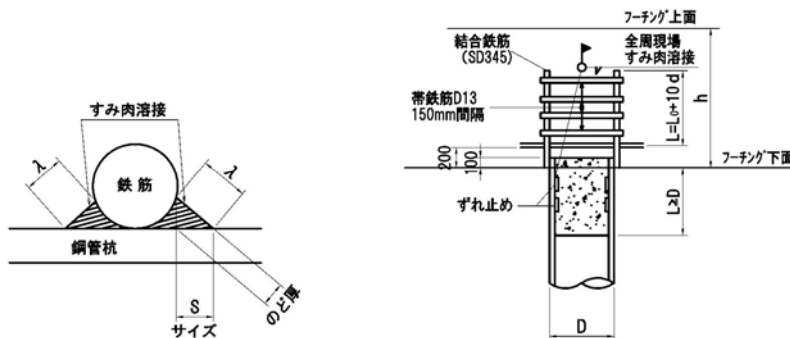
鋼管杭における「方法B'」（杭本体に結合鉄筋を溶接する場合）
